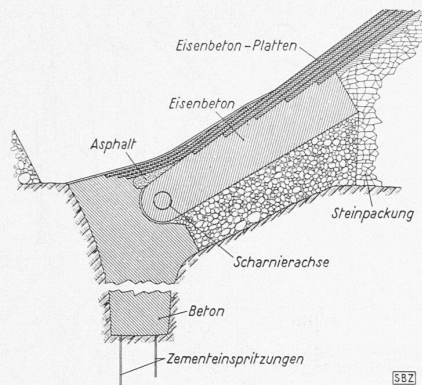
Querschnitt 1 : 250 der Herdmauer mit Scharnierstück und Anschluss der Betonplatten-Decke
